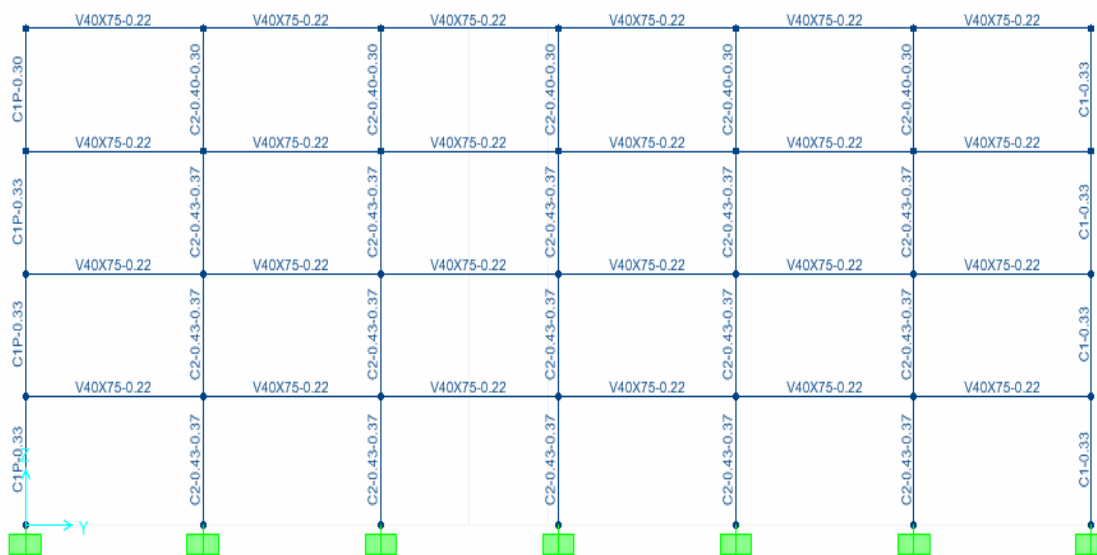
Pórtico del eje 2 indicando los factores de reducción de columnas y vigas en dirección Y
